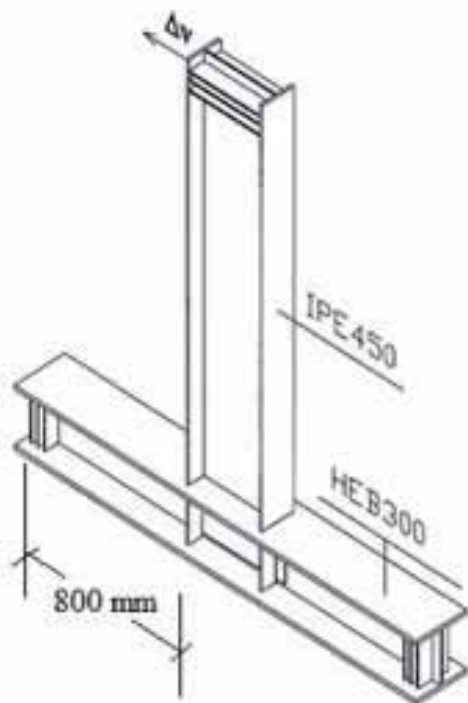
Schema di prova. Campione di tipo C. La colonna è disposta in orizzontale.
